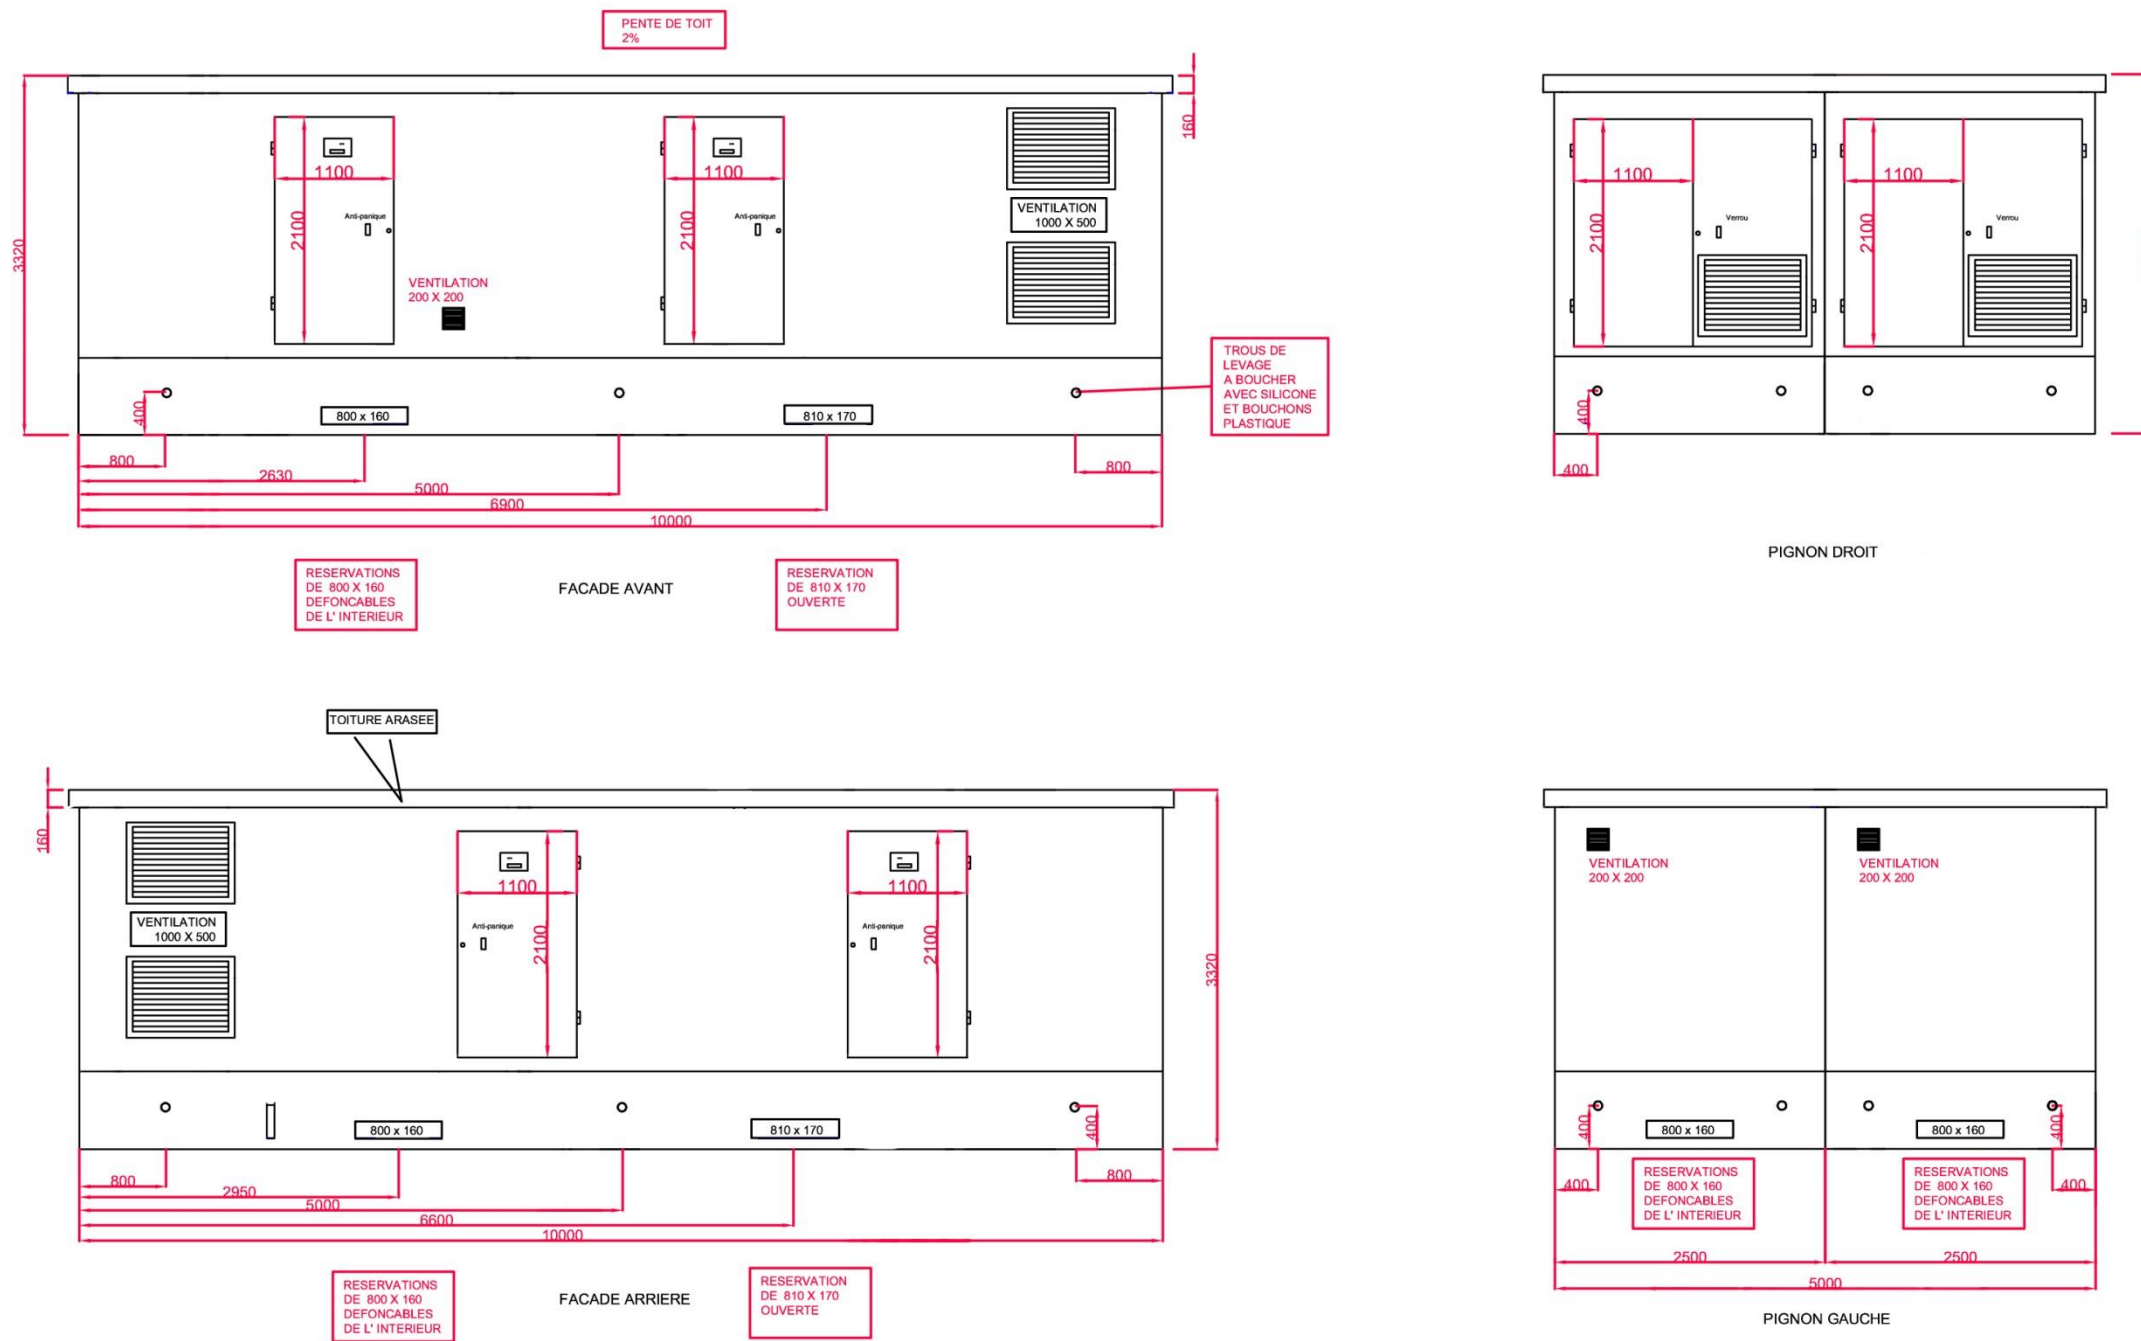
Exemple de plan d'un poste de livraison de 5 x 10 mètres (double)
